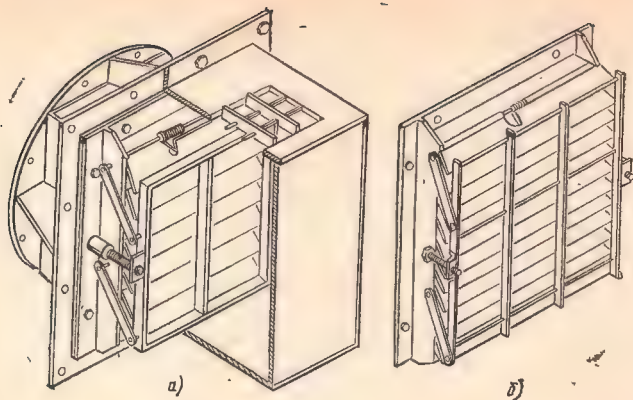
Противовзрывные устройства пластинчатого типа:
